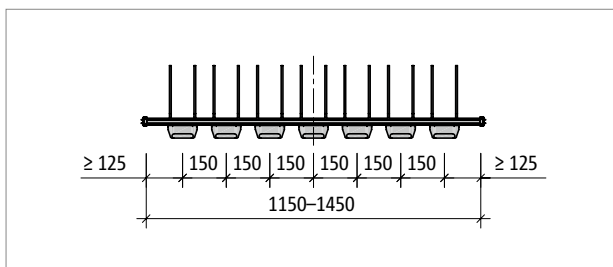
Schöck Tronsole® typ T-V6...-L1000 až L1300: Půdorys prvku
